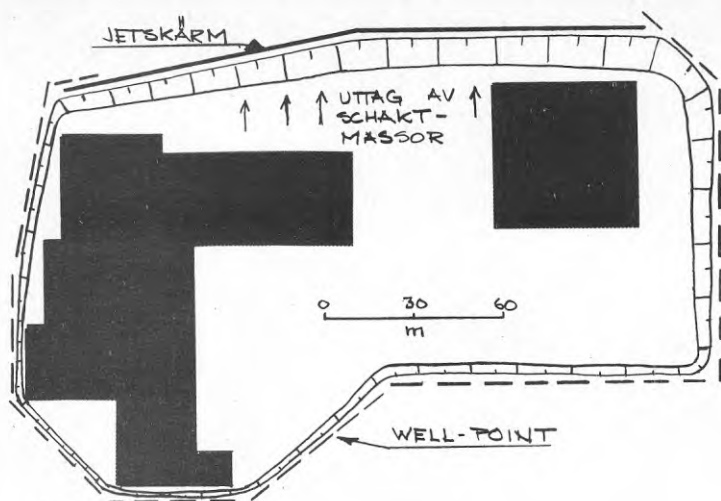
Tättningsåtgärder Muramatsuprojektet, plan.
